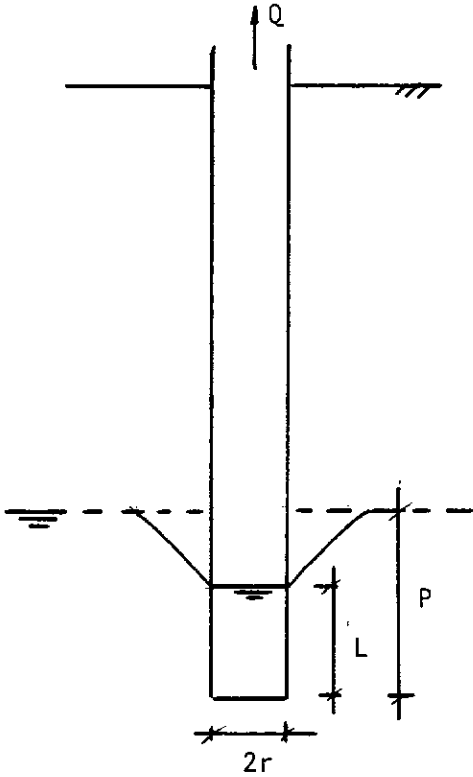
Ensaio de infiltração em poços de prospecção
